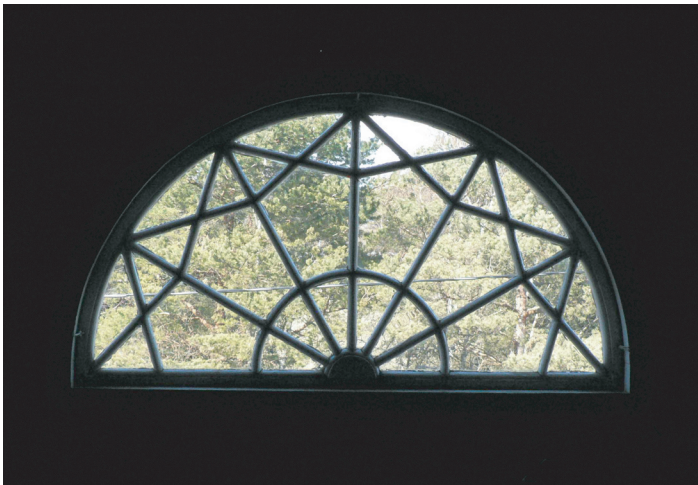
Esifassaadi poolkaaraken (autori foto 2008).
